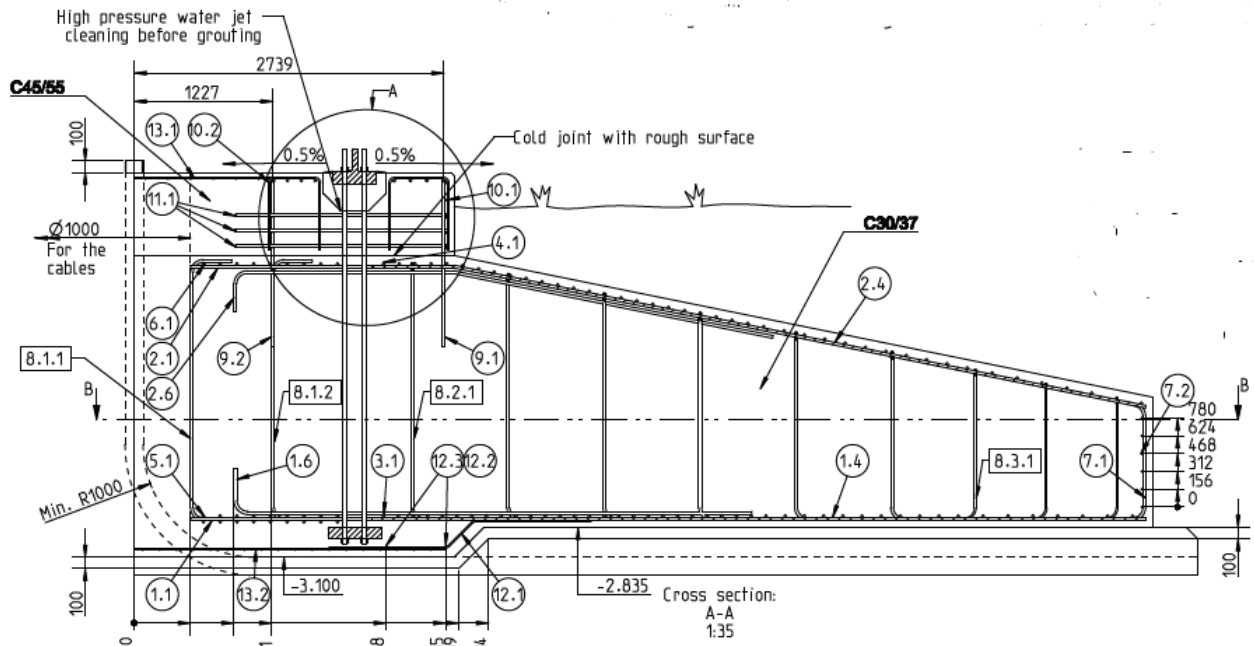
Sezione fondazione tipica VESTAS V117 con indicazione ferri di armatura
